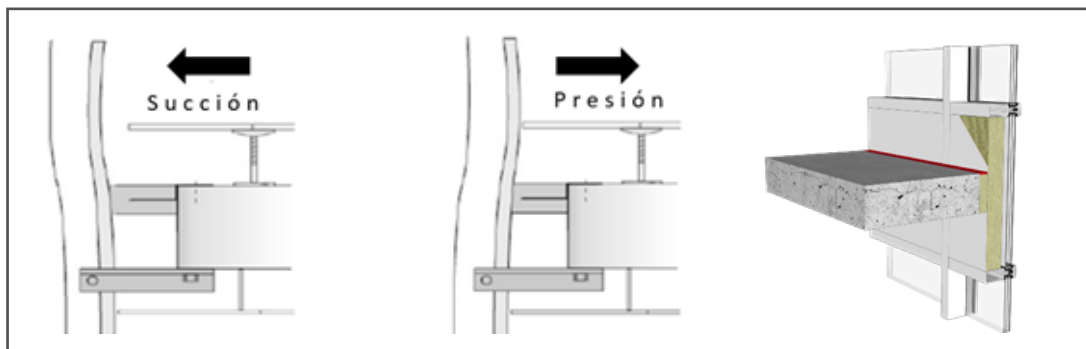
Los elementos cortafuego situados en el encuentro del forjado y la fachada deben ser flexibles para soportar cargas de viento (izquierda). Detalle constructivo específico para muros cortina con barrera cortafuego de lana mineral y recubrimiento de película elastomérica (derecha).
